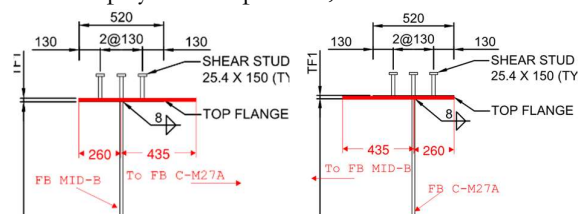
Esquema de alas de las 2 vigas transversales que se modificaron para el cierre.
